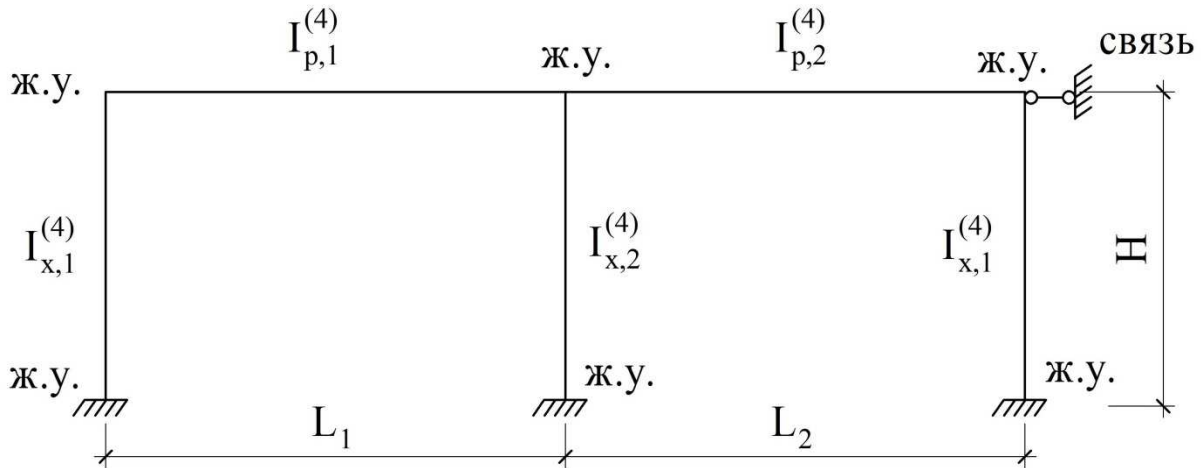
Расчетная схема двухпролетной несвободной поперечной рамы: верхние узлы и нижние - жесткие; поперечные сечения колонн - постоянные; ригеля - эквивалентные стержни
